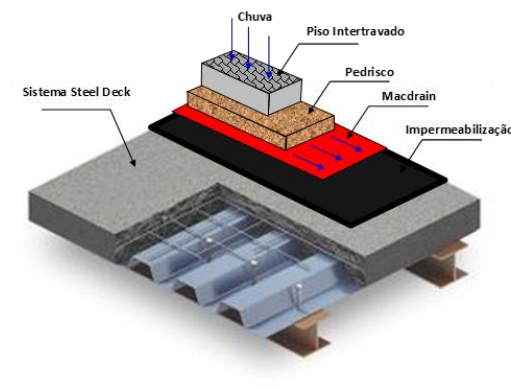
Esquema de aplicação do Macdrain sobre o piso de concreto.
